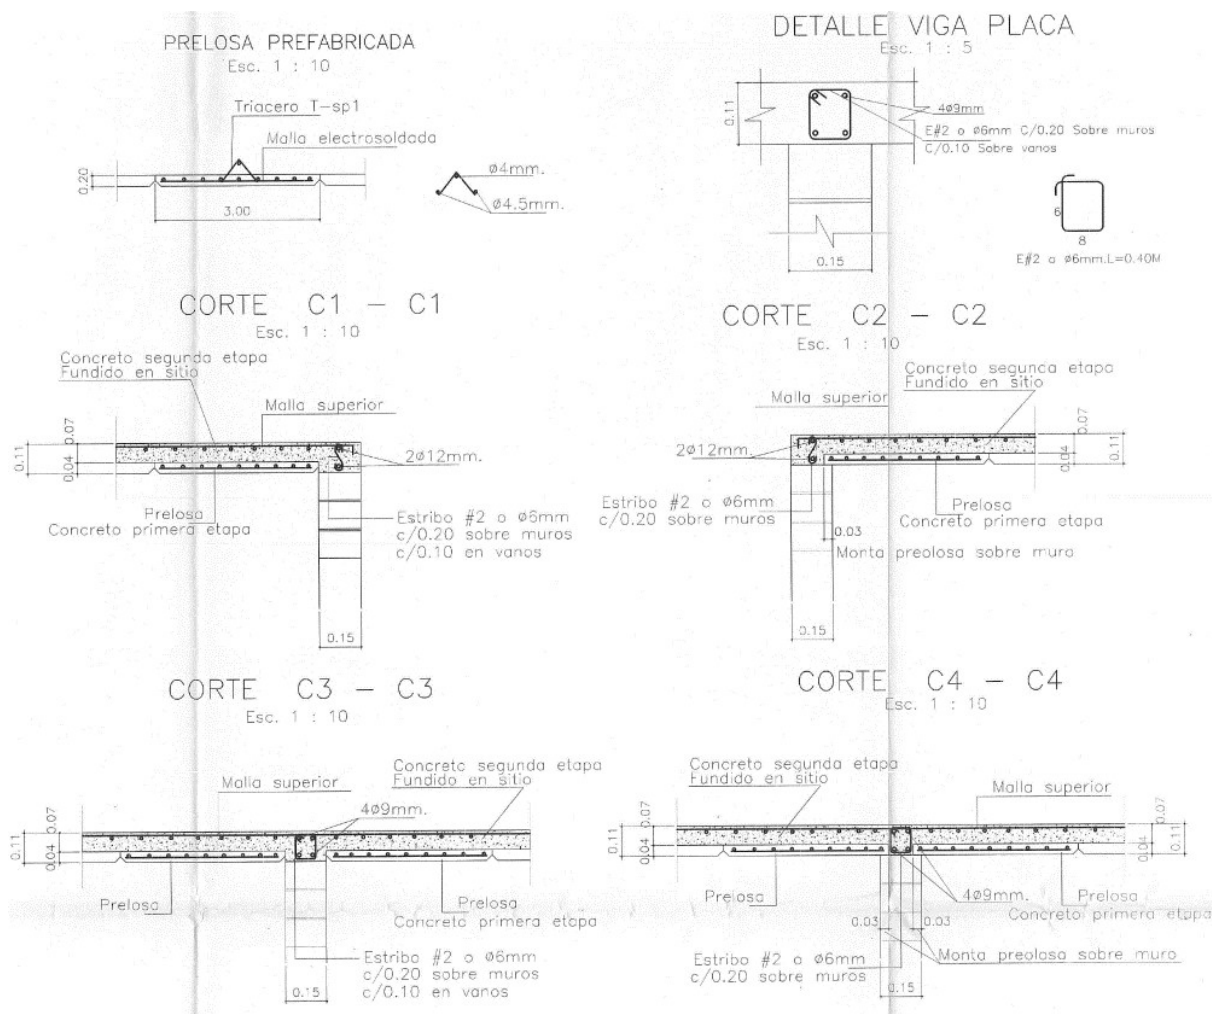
Detalle refuerzo losa entrepiso y vigas. (Fuente. Plano estructural 01).
